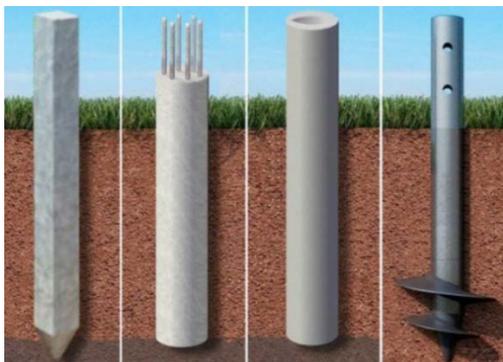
Виды свай под фундамент по методу погружения в грунт
